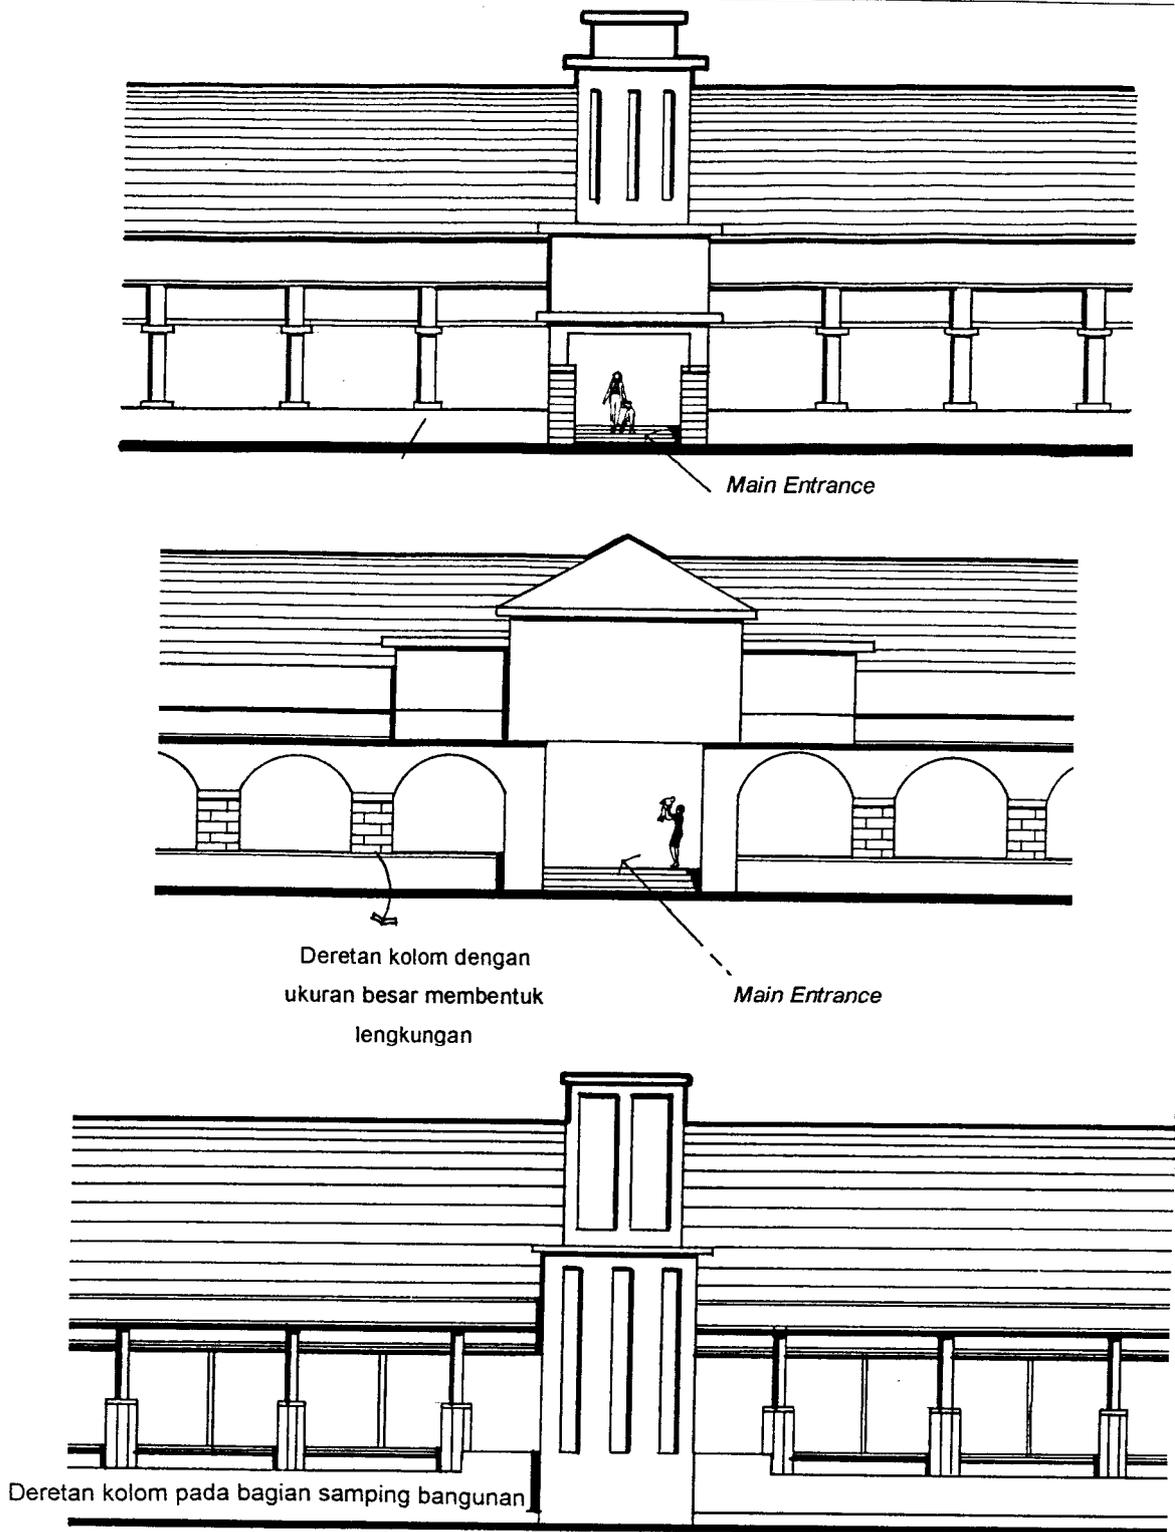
Detail Kolom Gedung HVA di Surabaya
